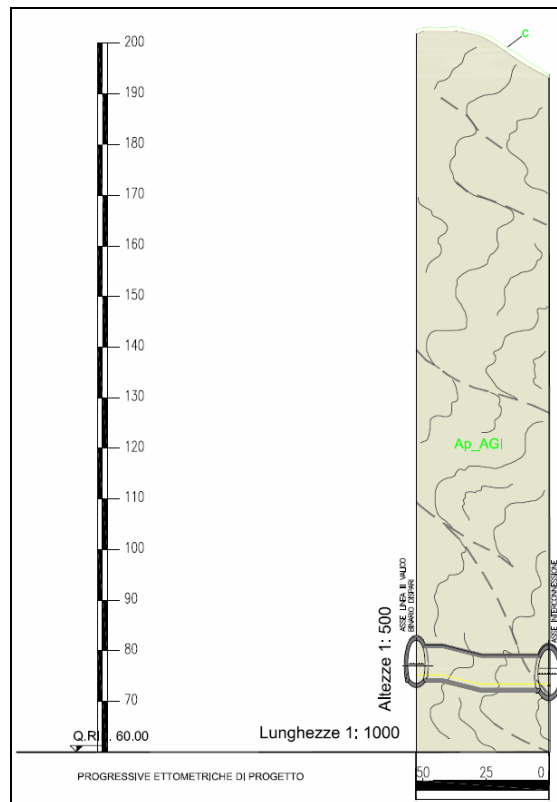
Stralcio profilo geomeccanico del by-pass di collegamento
